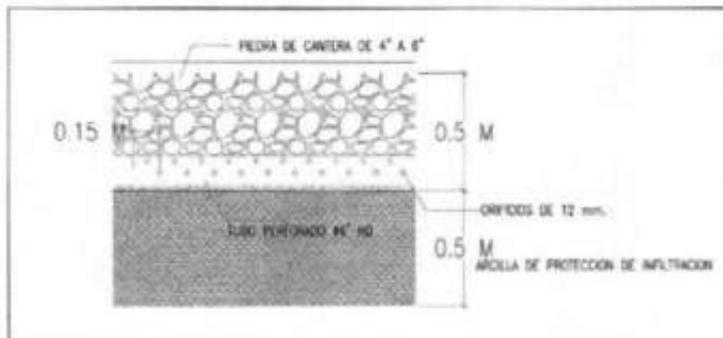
Corte Transversal y Lateral del Drenaje de Lixiviados.
